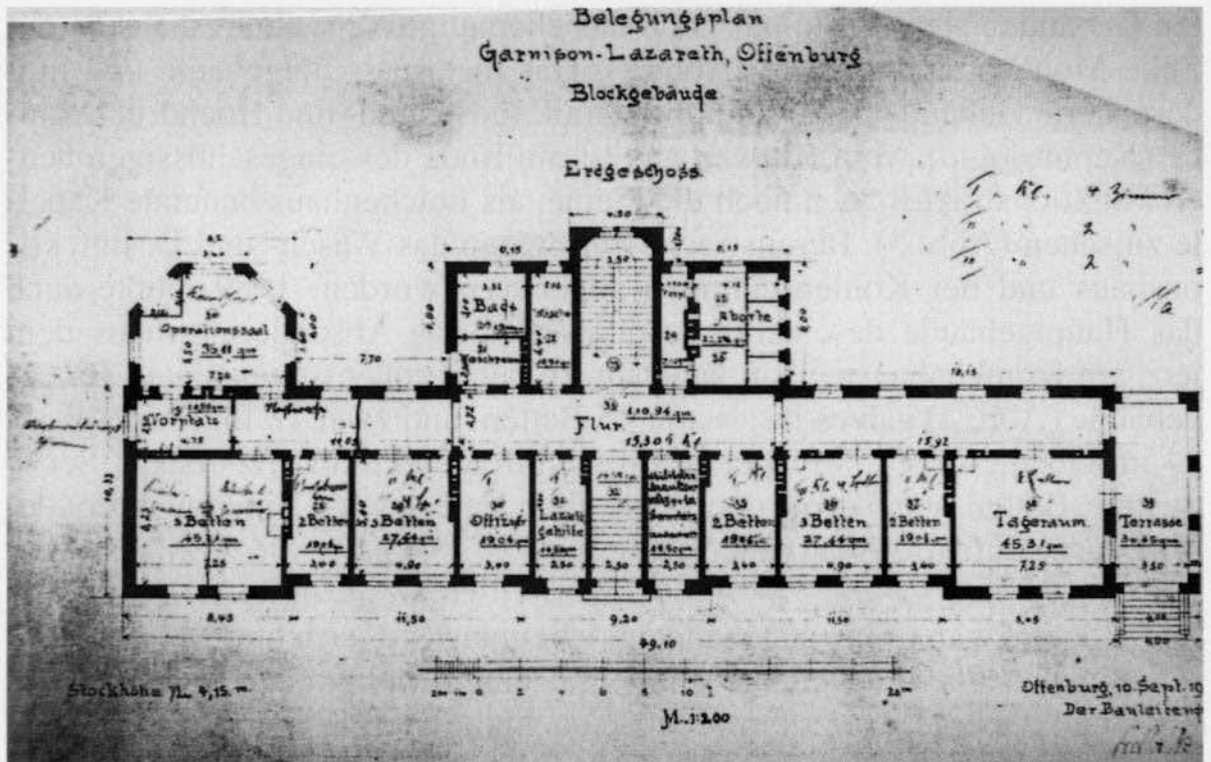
Grundriß mit Belegungsplan für das Erdgeschoß des Krankenblockgebäudes.
